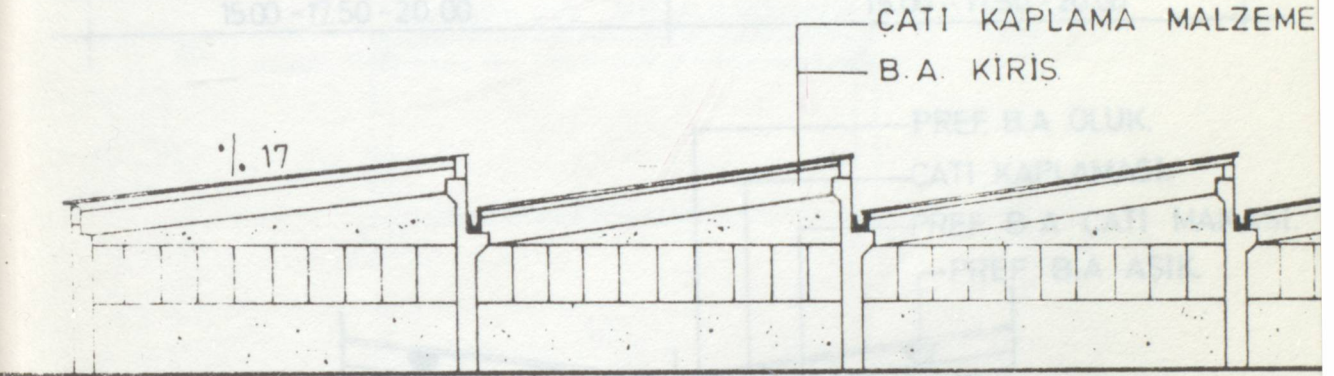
Beton taş tarafından yapılan sanayi yapısında
